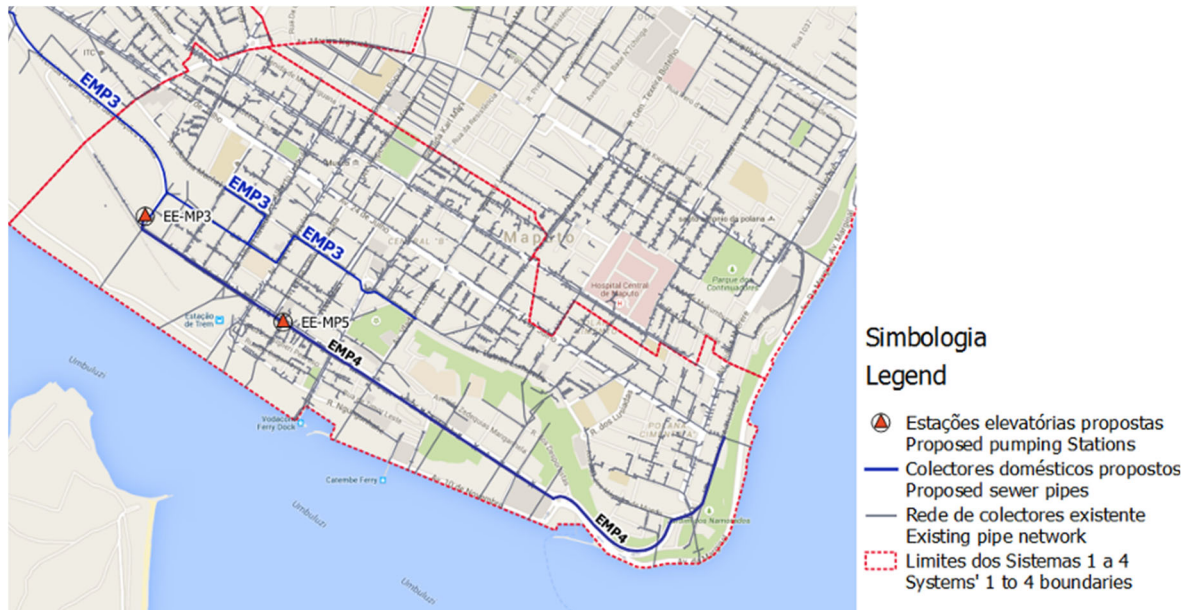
Ilustração esquemática do traçado em planta do futuro sistema intercepto de águas residuais domésticas
